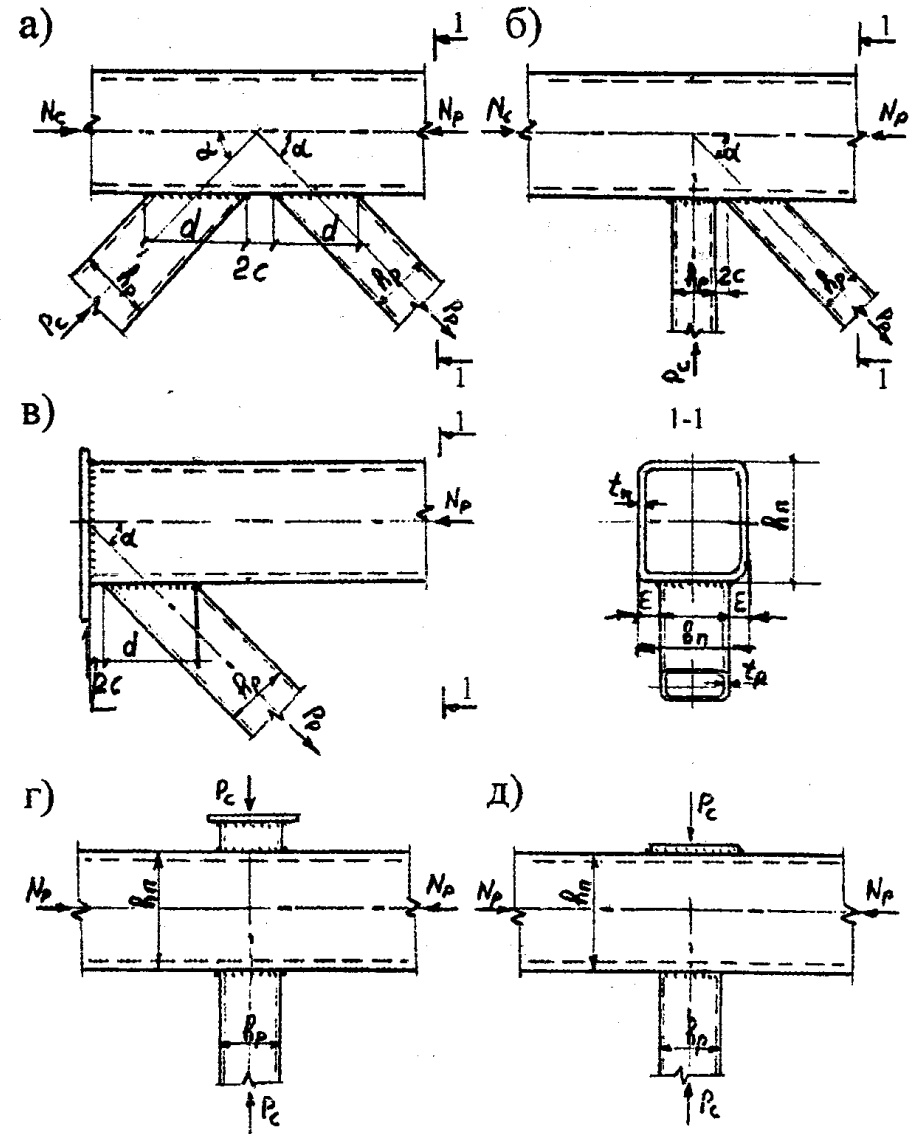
Типы бесфасоночных узлов ферм из прямоугольных труб
